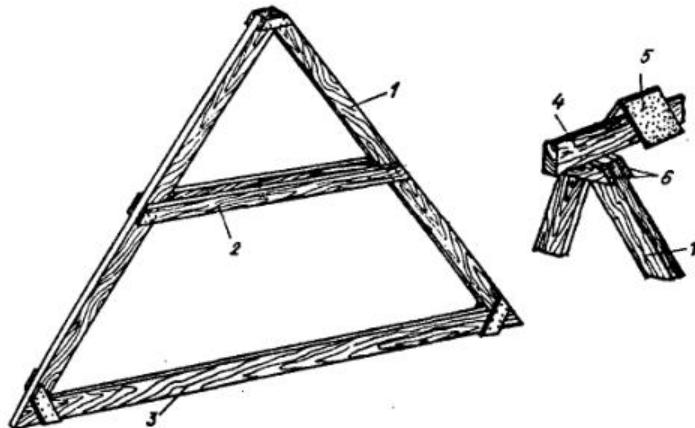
Стропильная рама: 1 — стропило; 2 — ригель жесткости; 3 — балка перекрытия; 4 — конек; 5 — покрытие; 6 — коньковые накладки.
